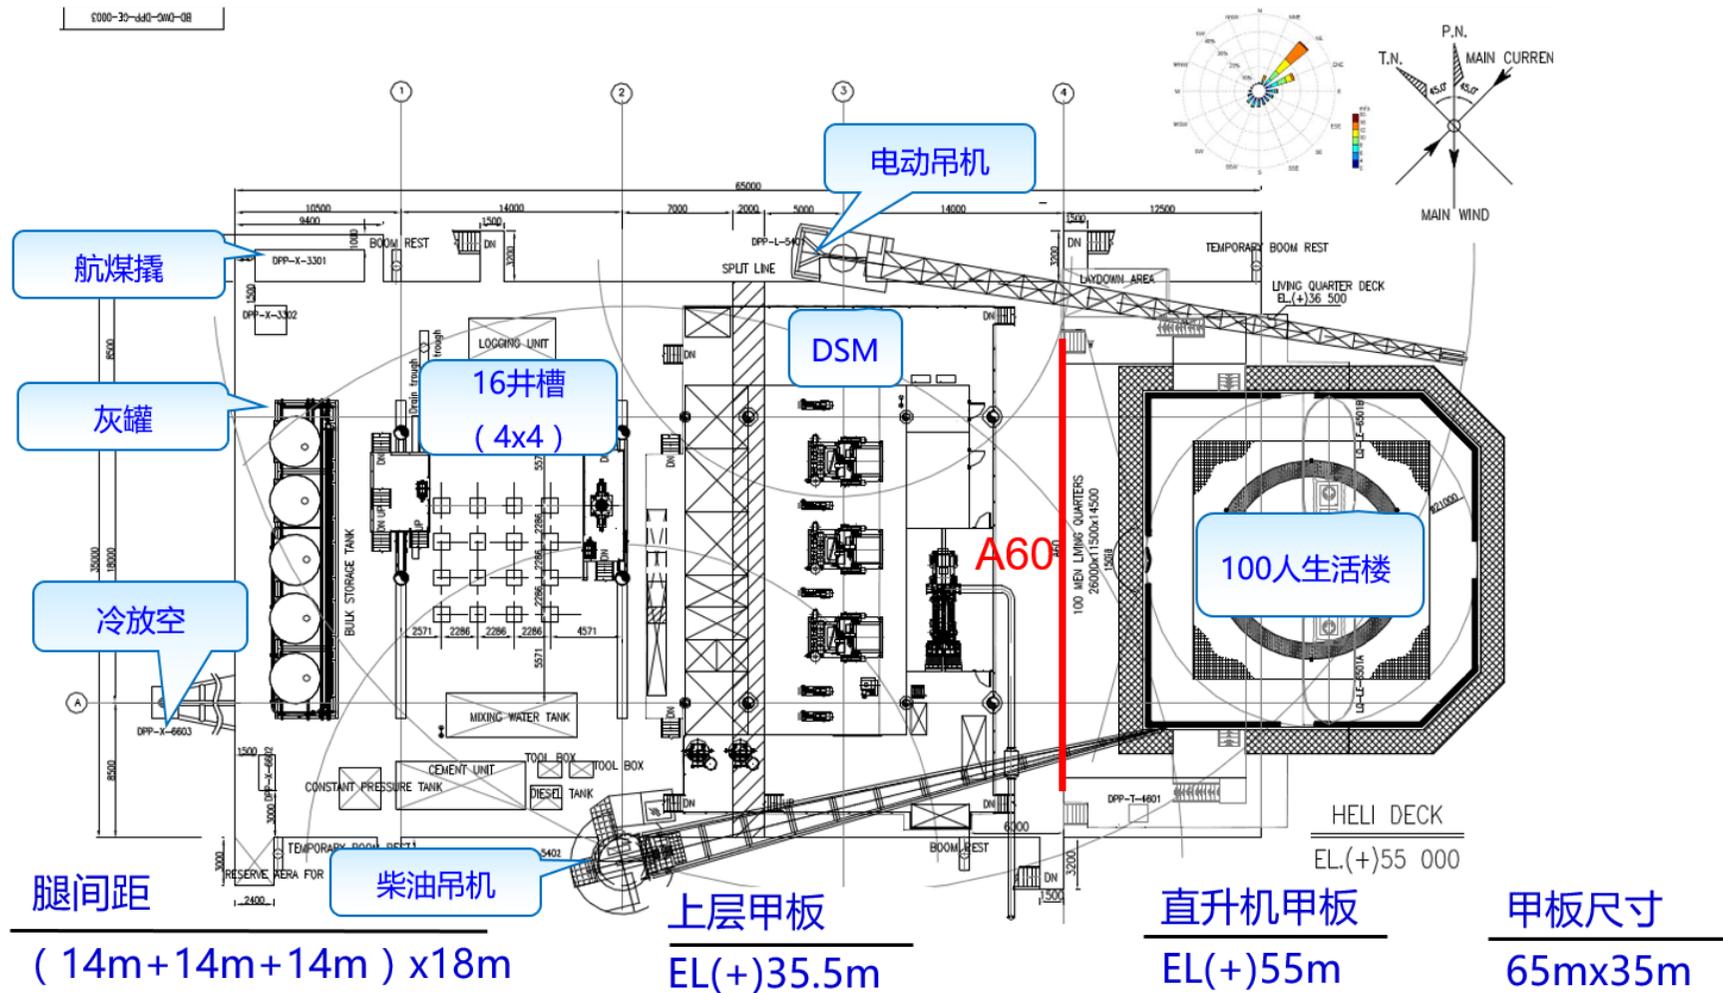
LF15-1 DPP 平台上层甲板平面布置图
